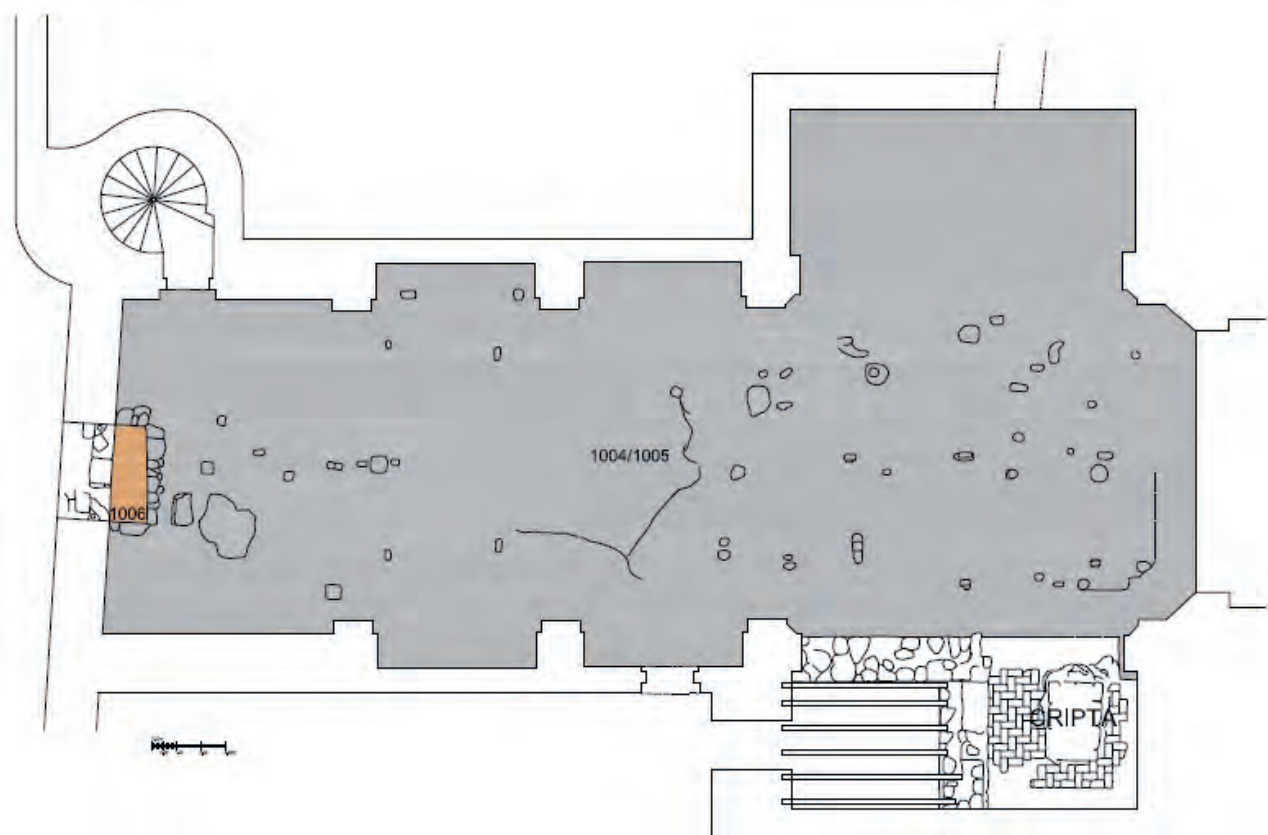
Planta general de l'excavació. Fase 3 en procés de construcció. Segles XVII-XVIII.
